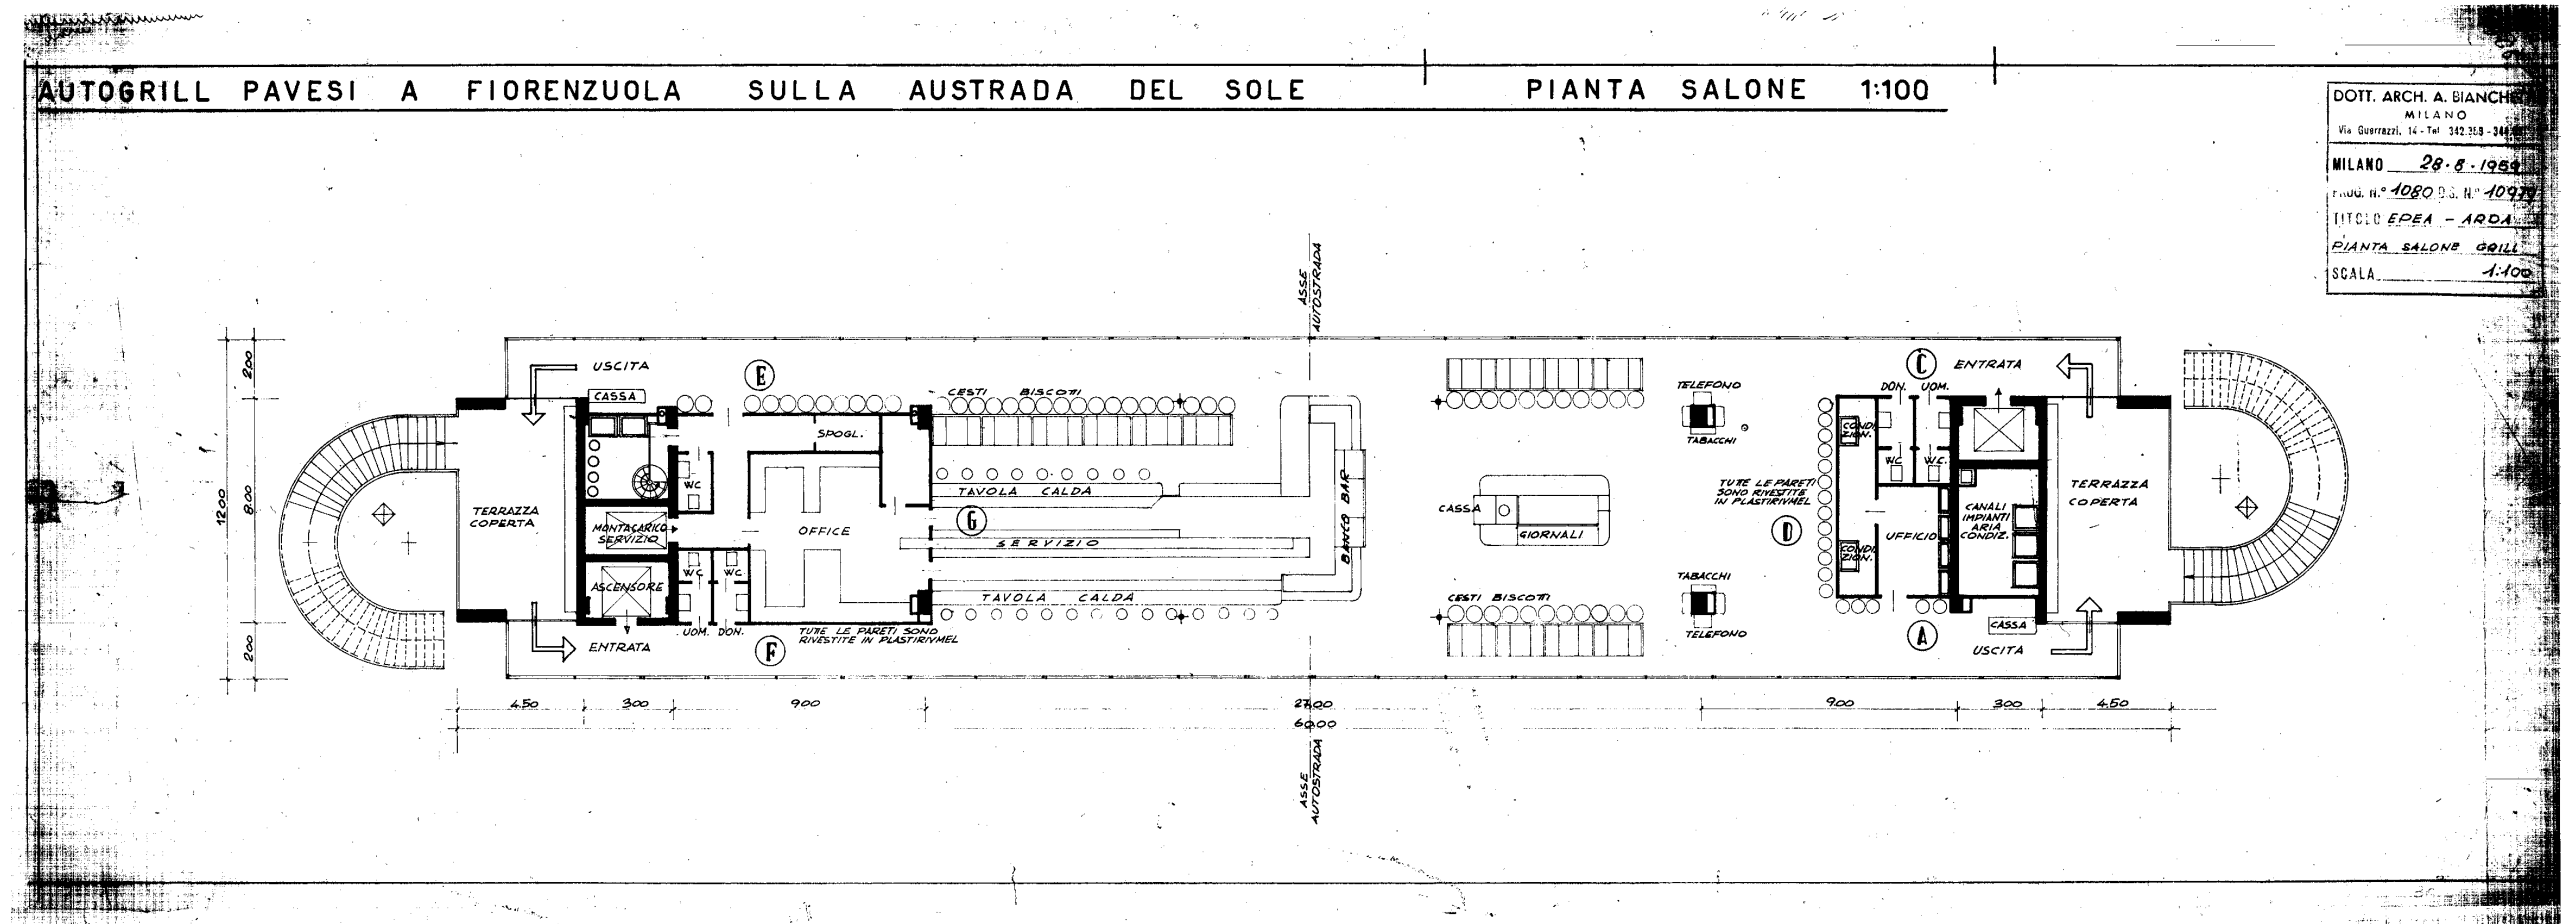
Pianta piano grill del punto Pavesi di Fiorenzuola (AAB)
